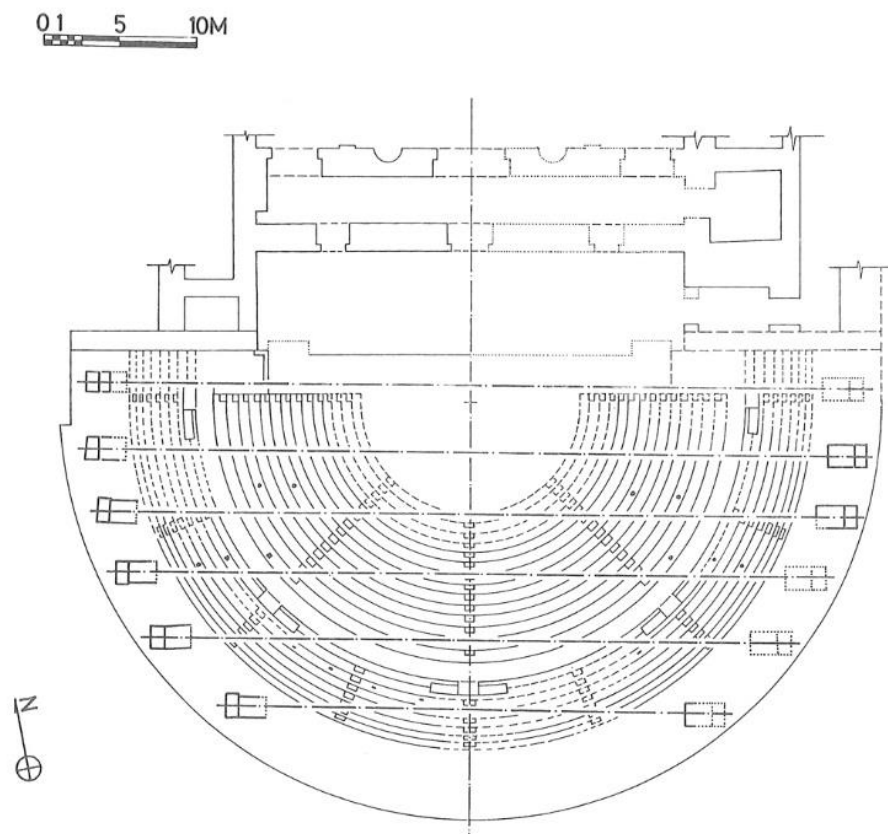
Plan du théâtre nord de Jérash d'après J. D. Stewart
